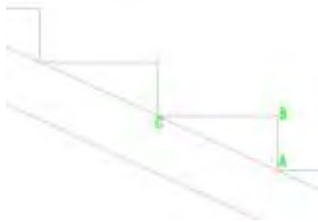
23 Panjang Miring Tangga Tipe 6
